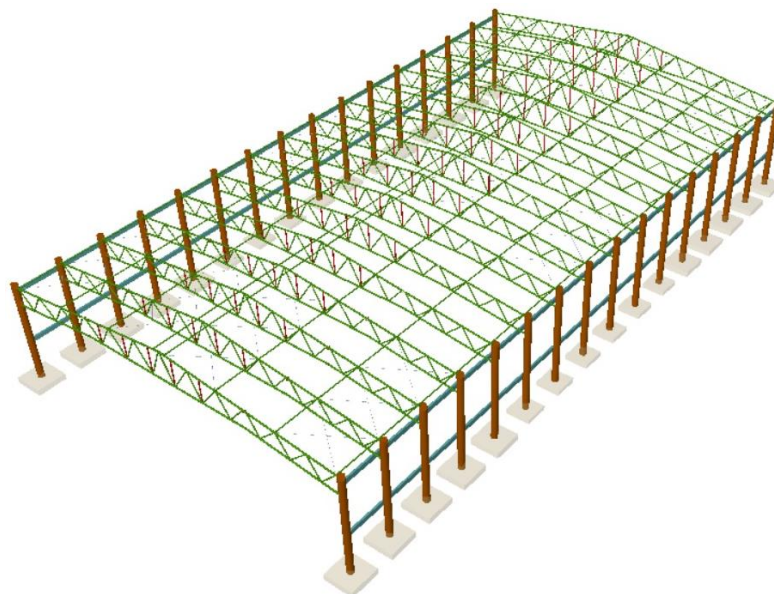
Esquema estructural. Fuente: Autoría propia.
